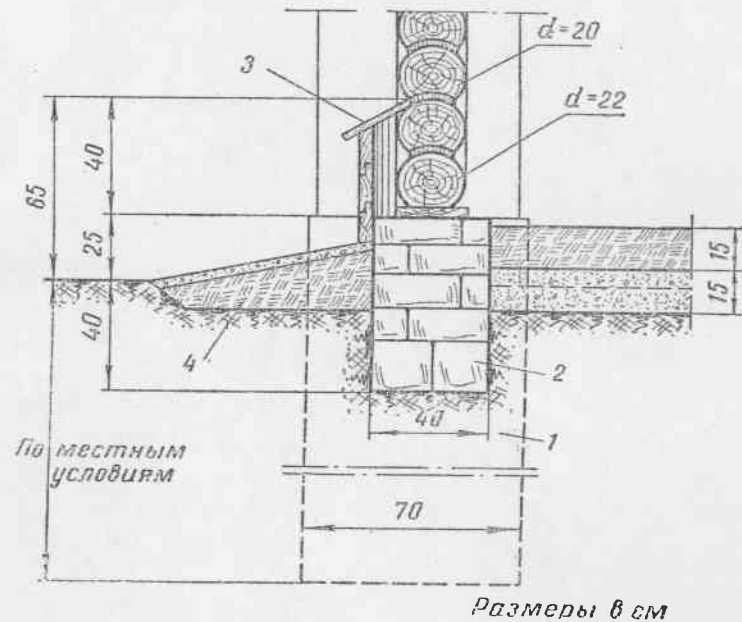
Прерывный фундамент с забиркой из бута: 1—фундаментный столб из бута; 2—забирка из бута; 3—дошки цоколя толщиной 2,5 см; 4—утрамбованная глина.
